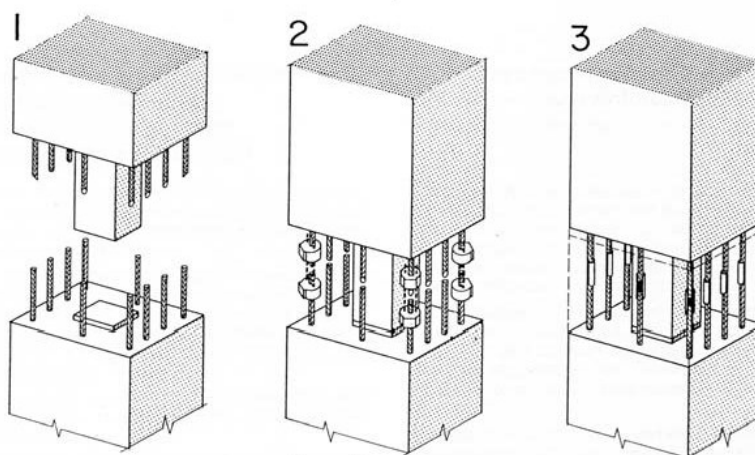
Ligação pilar - pilar recorrendo a ligadores de varões (STUPRÉ, 1981).
